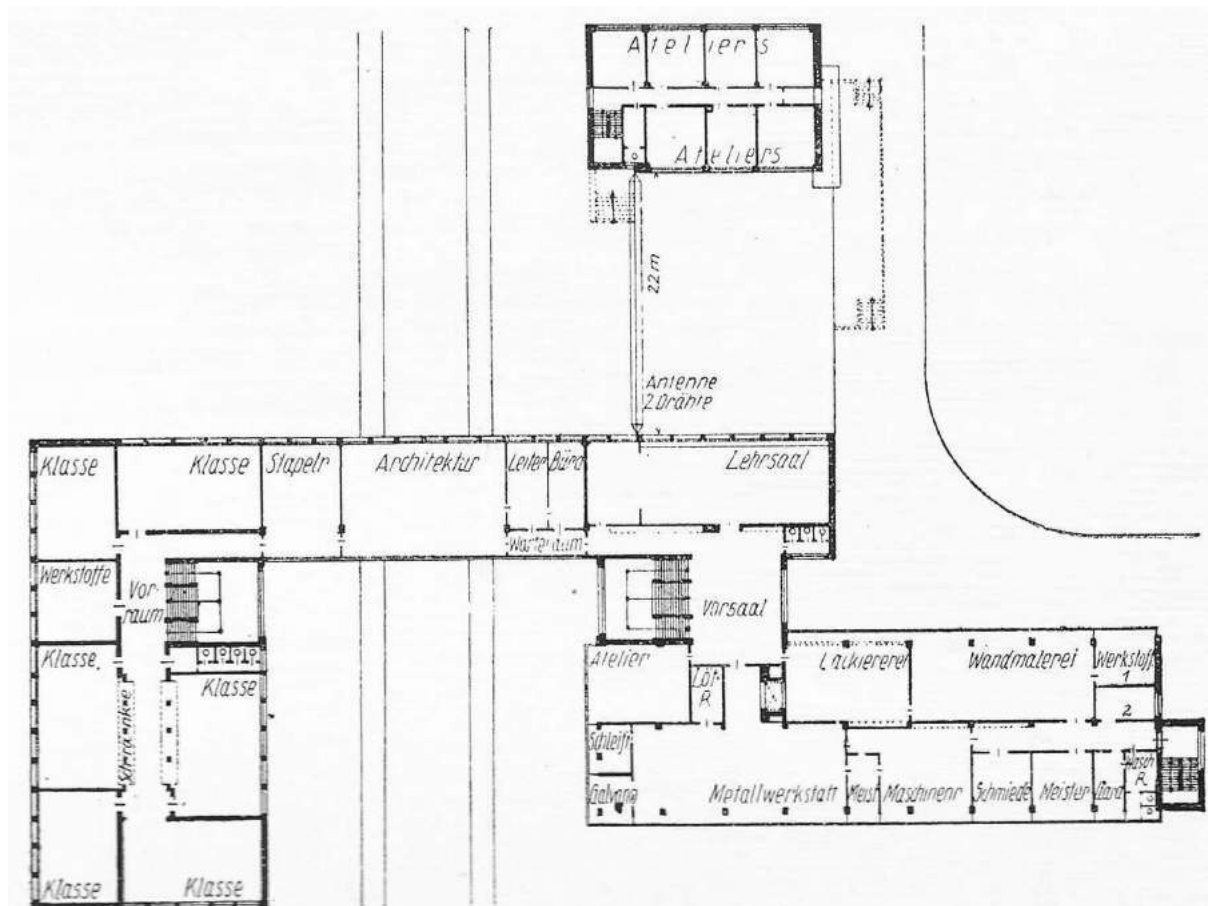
Grundriss OG; Im Westtrakt die Ateliers
